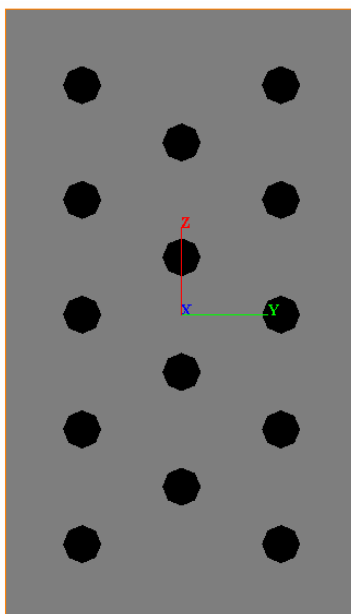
Vista planimetrica del modello GROUPv2016.
